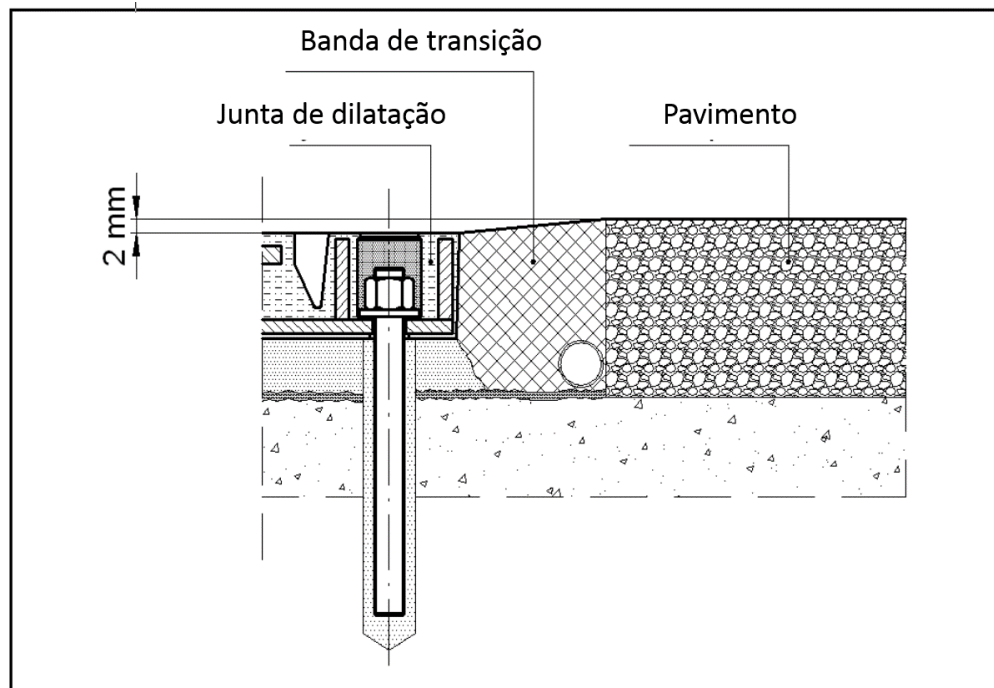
Pormenor da junta de dilatação e da banda de transição (adaptado de fonte:(AGOM, 2013b) )
